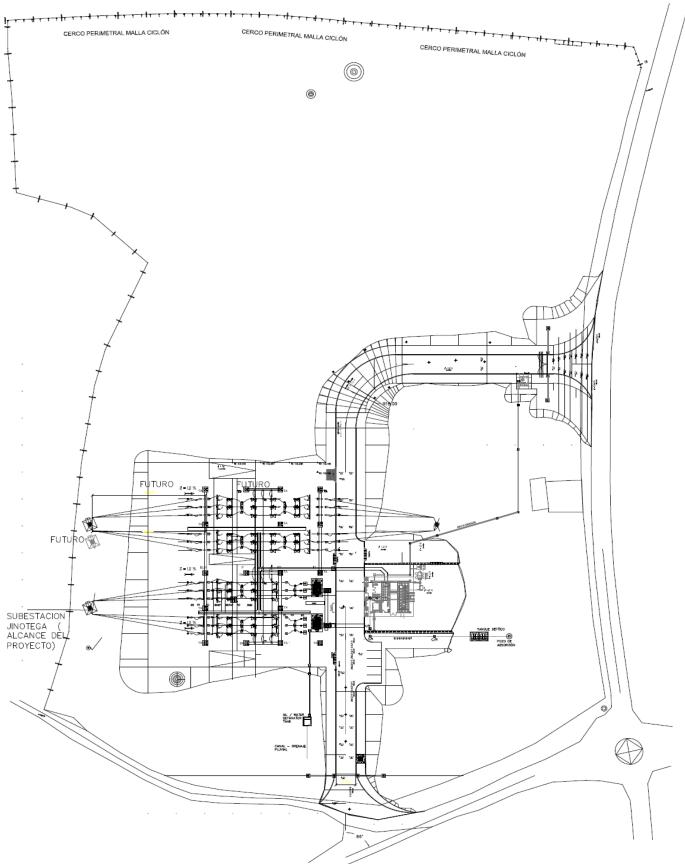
Plano de conjunto del proyecto de subestación Jinotega
